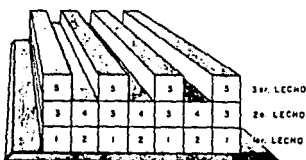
Secuencia de colado de pilotes de sección cuadrada.
